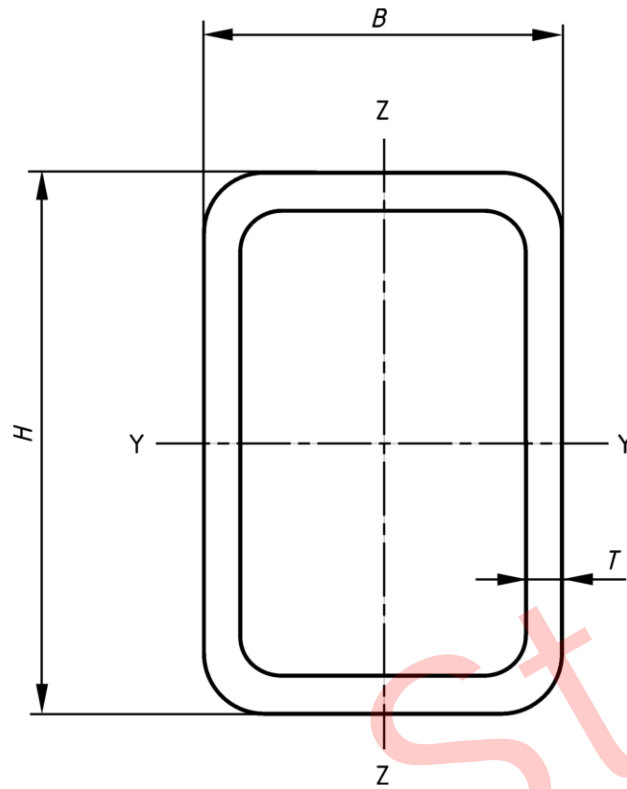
Hohlprofil mit rechteckigem Querschnitt
